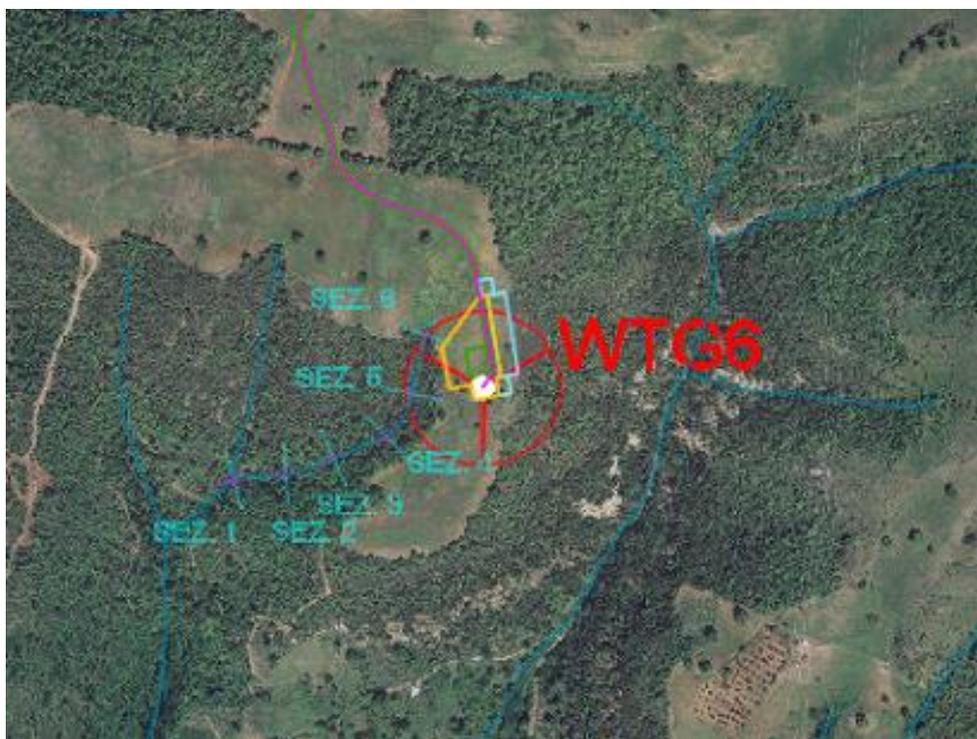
Planimetria con indicazione delle aree inondabili duecentennali
